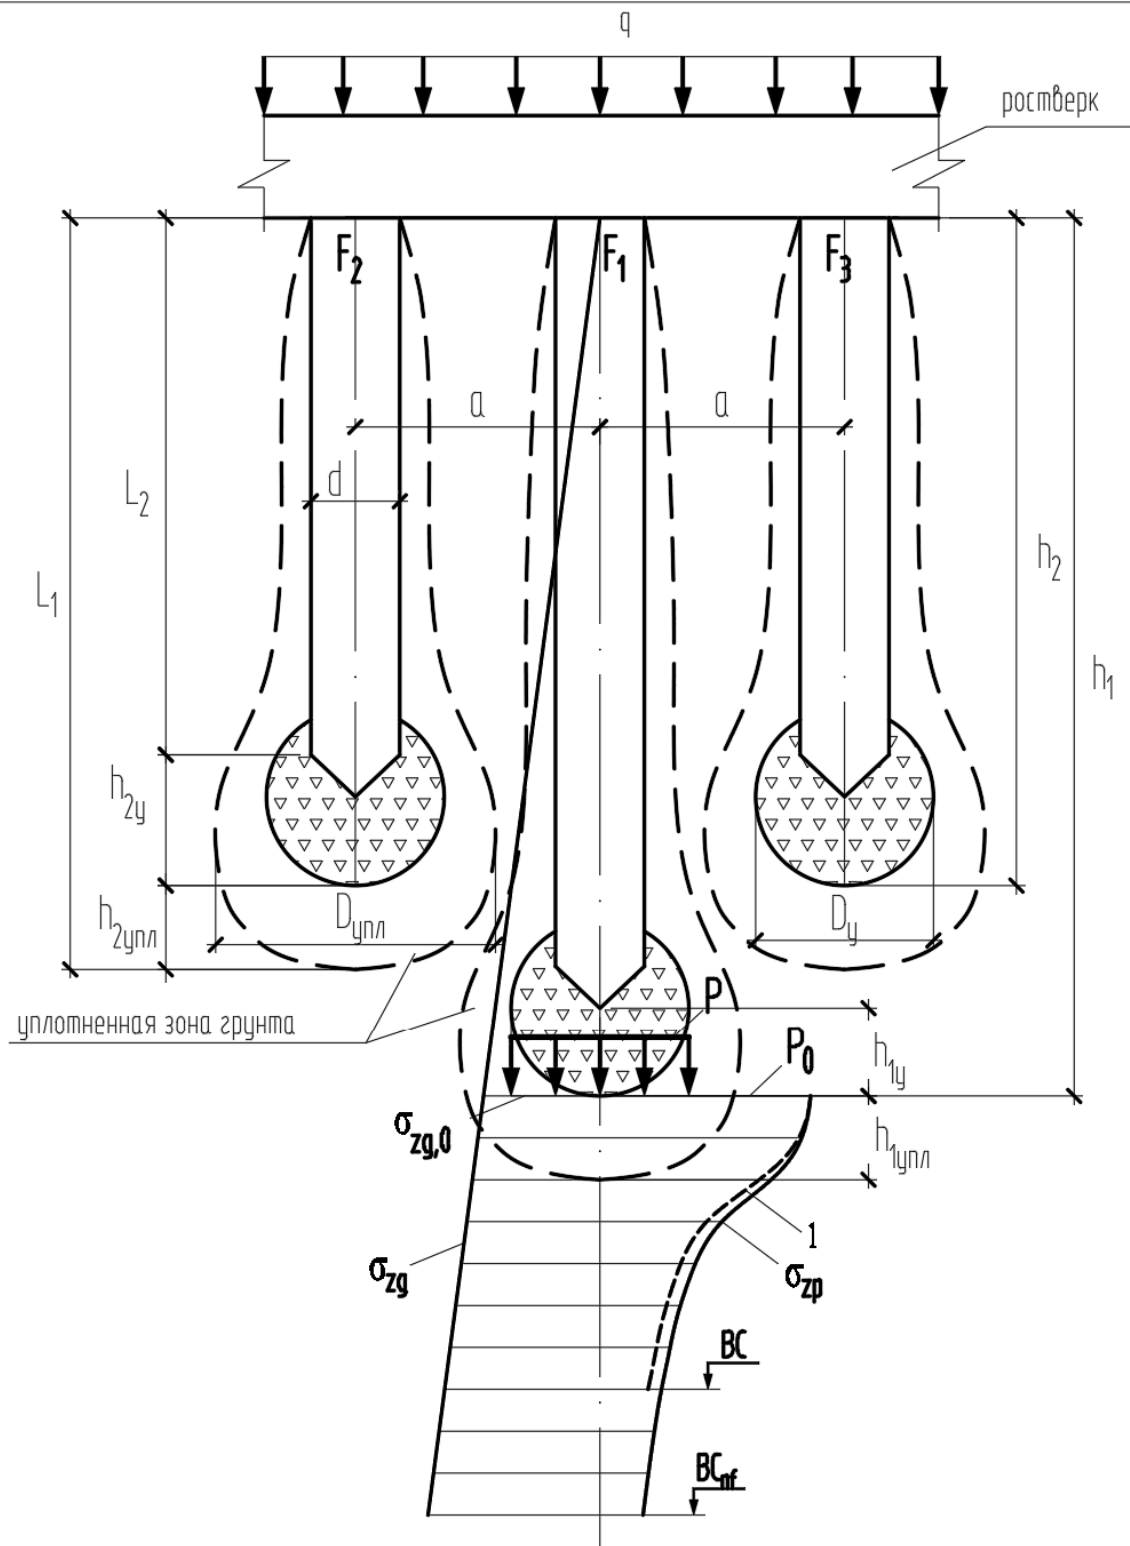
Схема расчета осадки ленточного свайного фундамента
